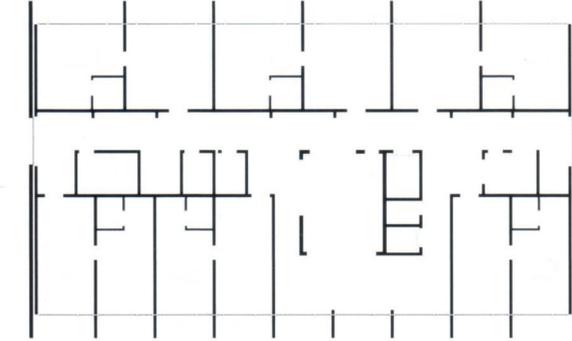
Grundriss Dachgeschoss M 1:500
